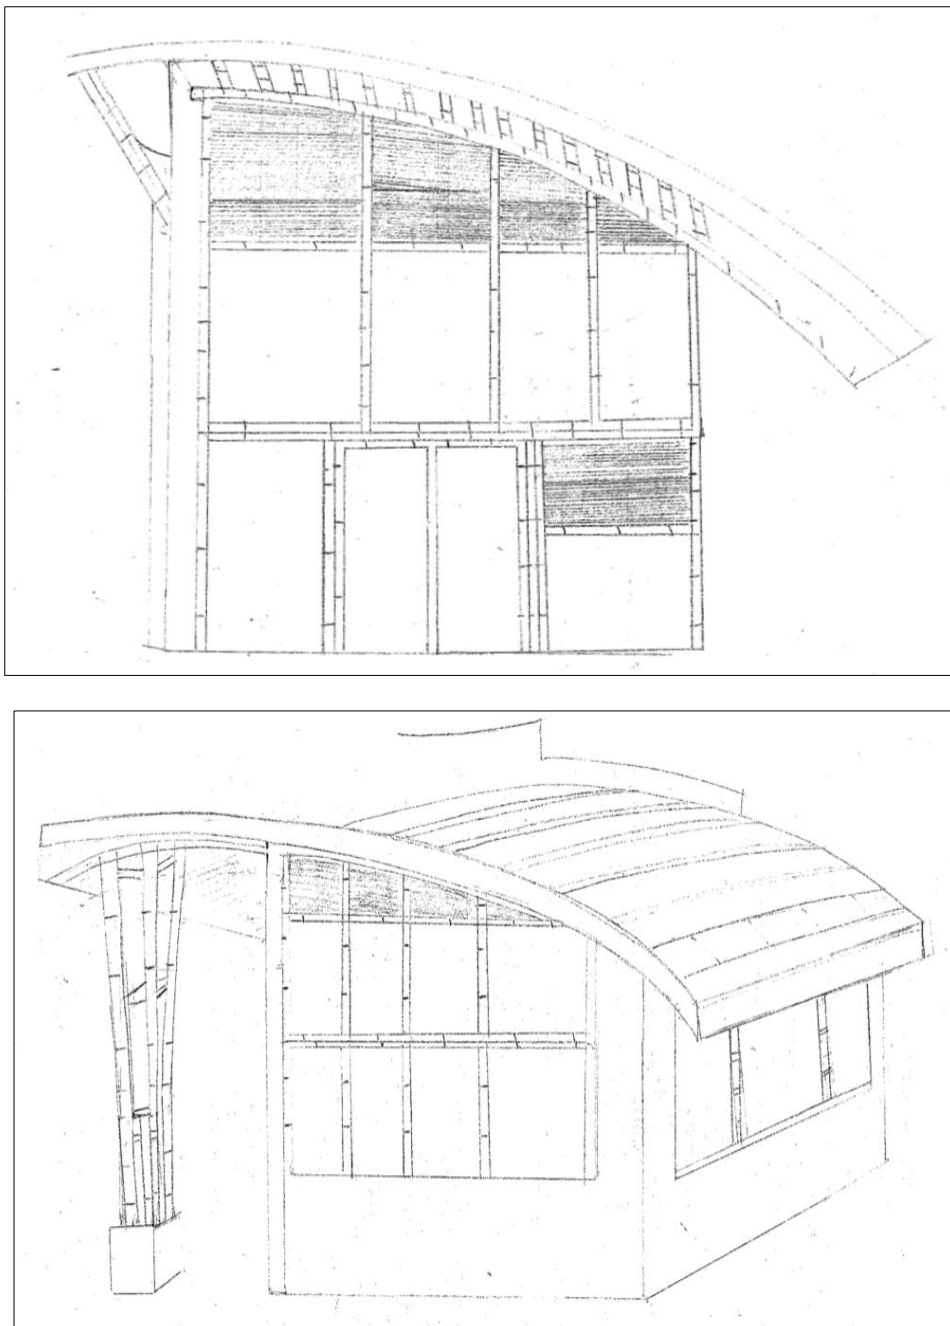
Propuesta Protección por Diseño a la Fotodegradación, Casa Condominio Campestre Las Pirámides Chinauta. Fuente Propia.
